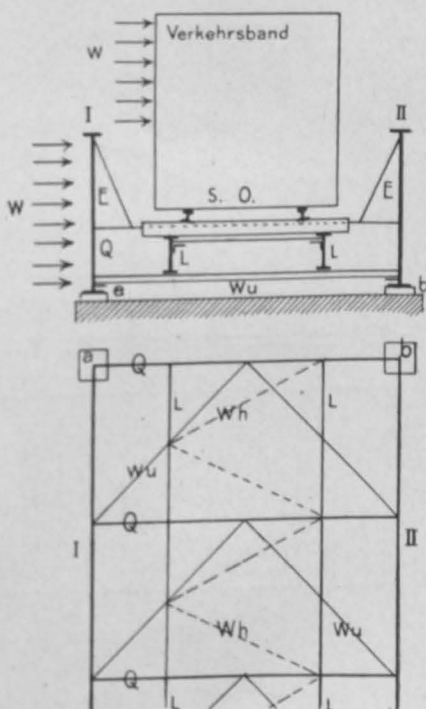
Querschnitt und Grundriß einer Eisenbahnbrücke. Hauptwindverband und Nebenwindverband.
